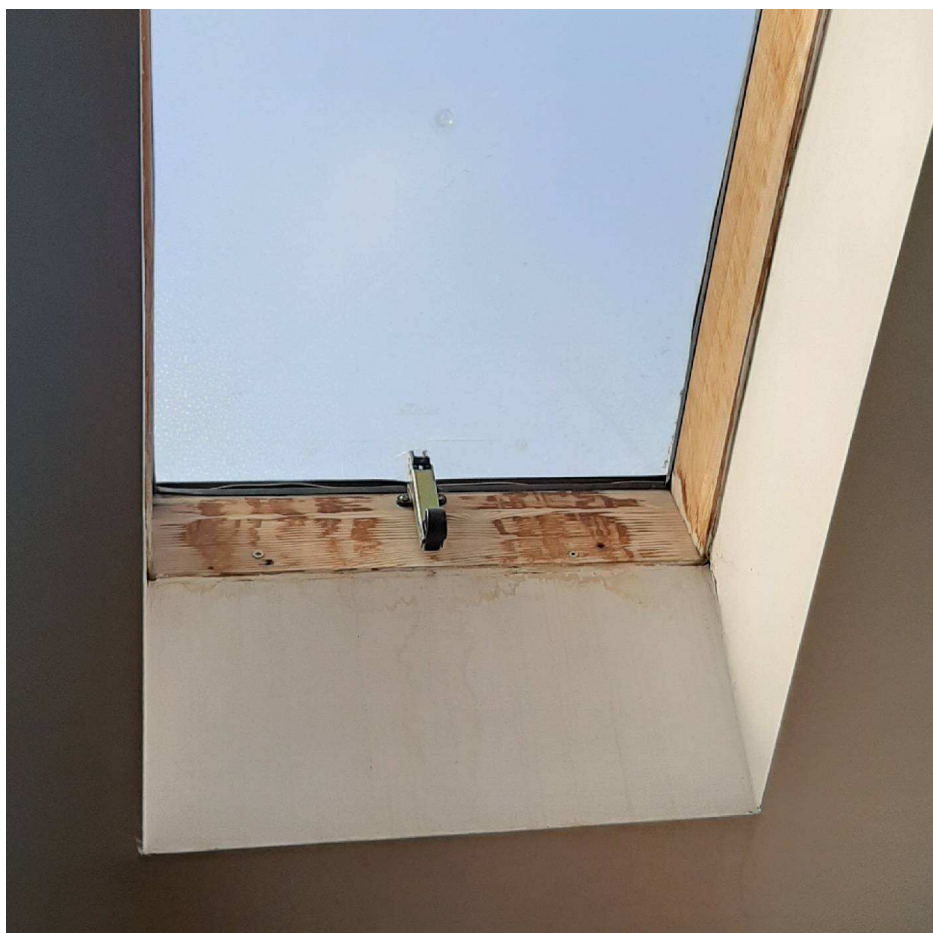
Widok na obróbkę wyłazu dachowego w części niższej dachu
